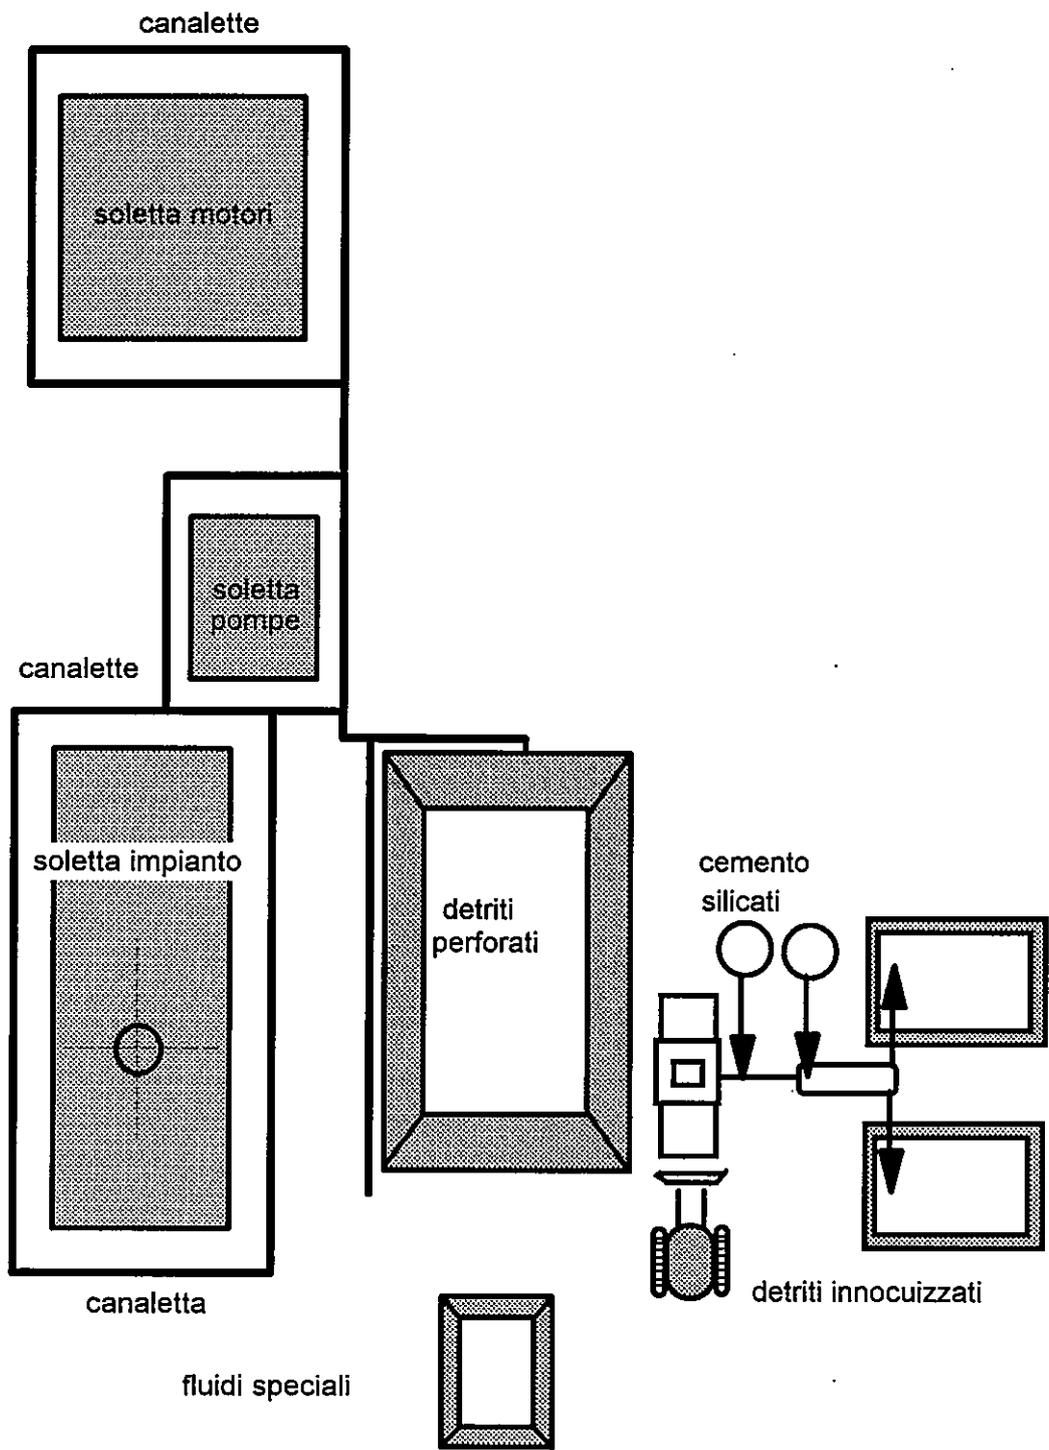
PLANIMETRIA POSTAZIONE A FINE POZZO DURANTE IL TRATTAMENTO
